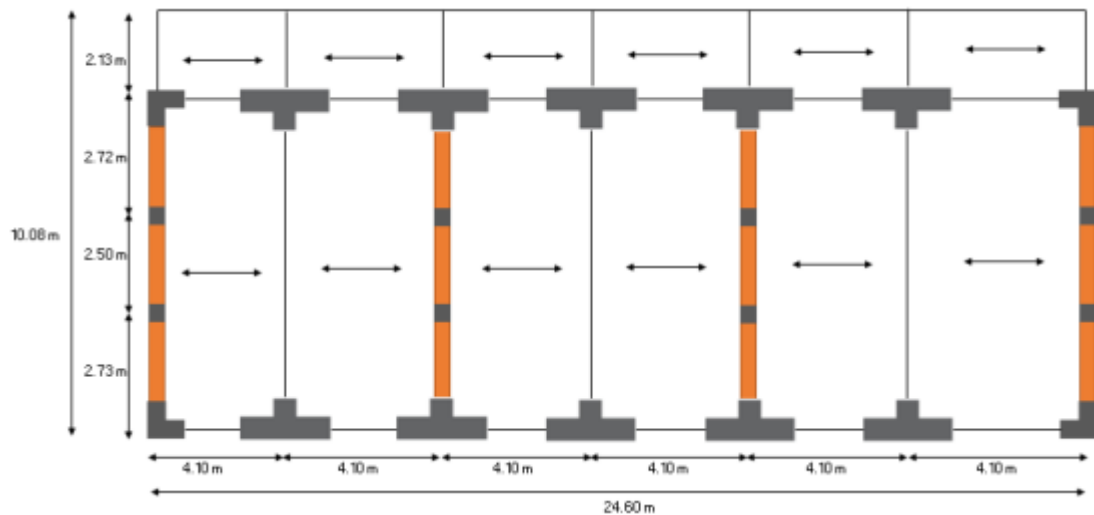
Vista en planta de Módulo Aulas 1,2,3
